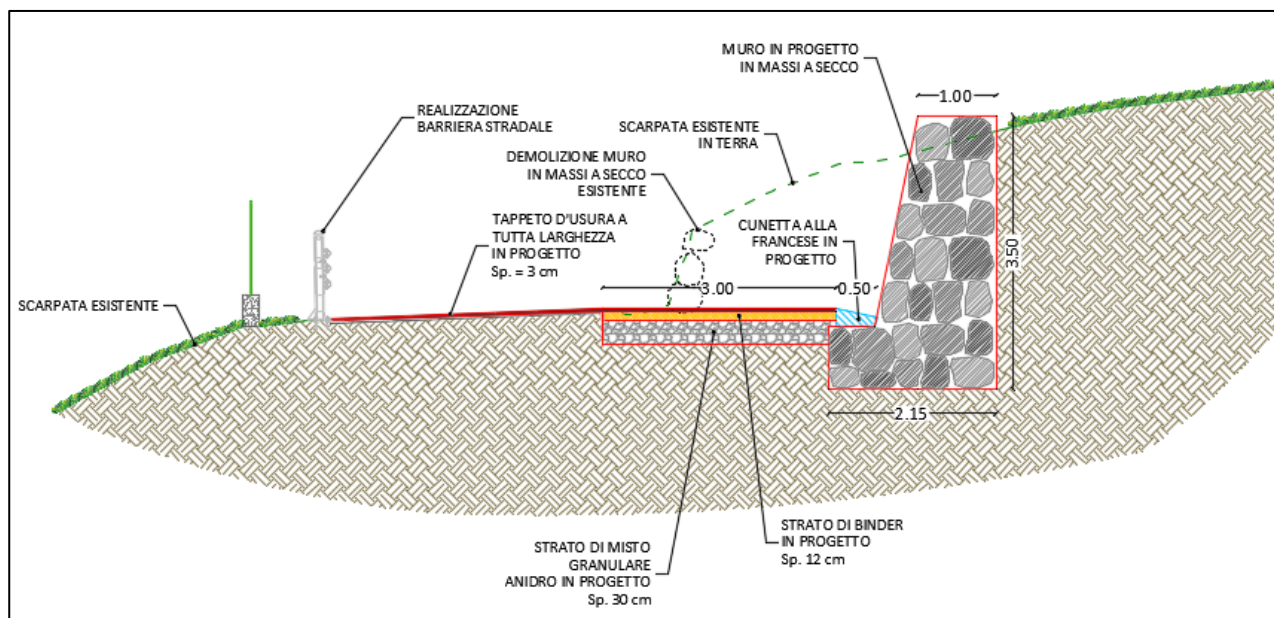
Sezione in progetto relativa all'intervento C, compresa di allargamento stradale, scogliera e barriera stradale.
